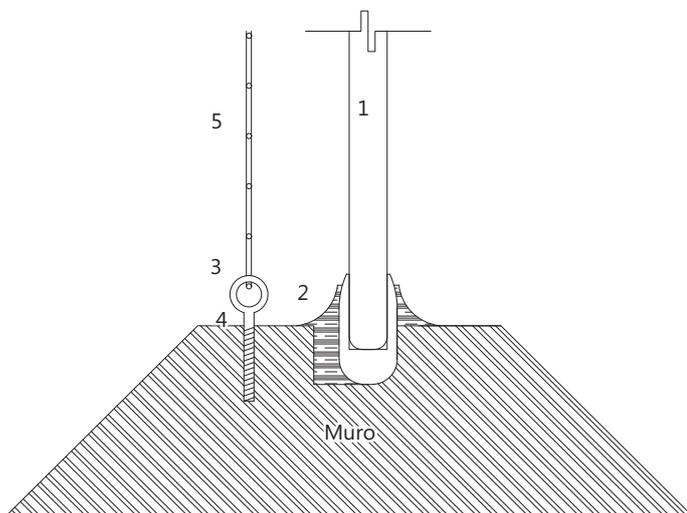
Detalle en sección de propuesta de vidriera con acristalamiento isotérmico y malla metálica. Elaboración propia.
